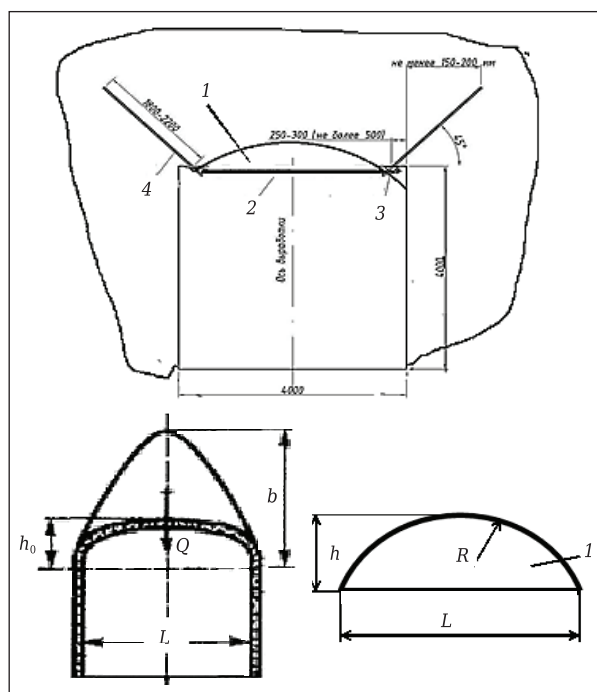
Схемы устройства анкерной крепи горных выработок: а — схема к расчету нагрузки на крепь при неустойчивой кровле прямоугольно-сводчатой выработки (1 — гибкая оболочка, 2 — перекрытие, 3 — стяжные элементы, 4 — податливые анкера); б — схема поперечного сечения арочного пространства при прямоугольно-сводчатой форме сечения выработки; в — схема для определения радиуса обнаженной поверхности кровли
